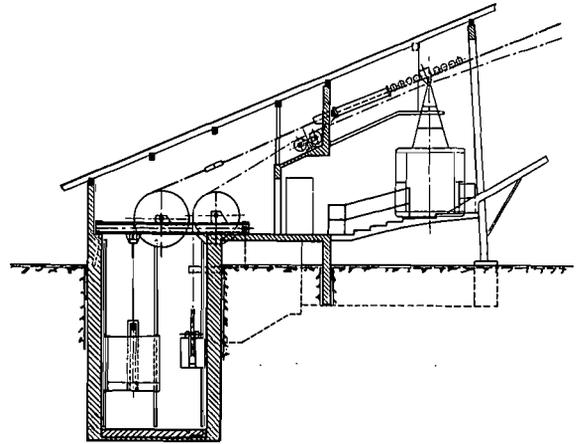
Talstation einer Personenseil-schwebbahn mit Pendelbetrieb
